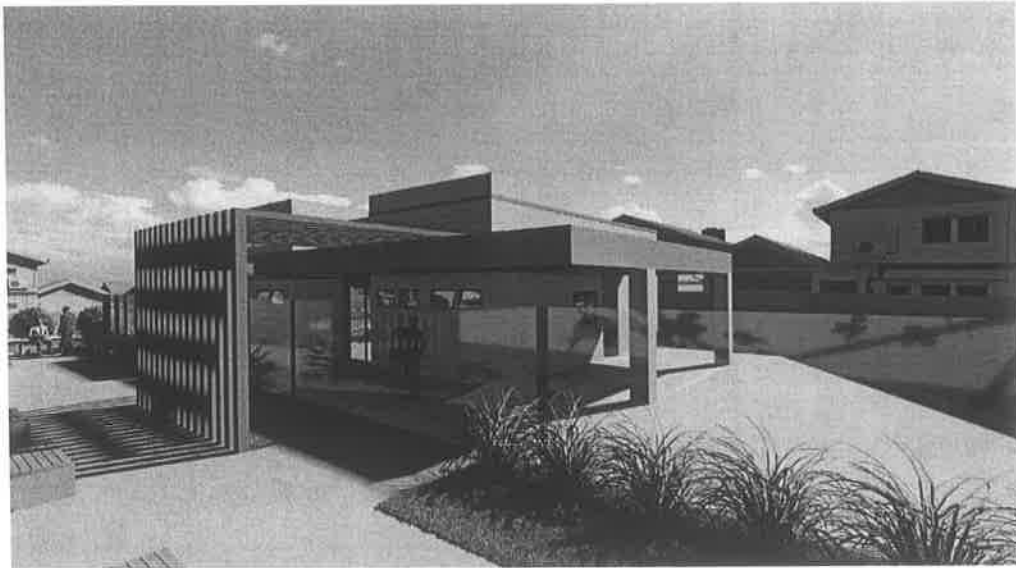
Imagem ilustrativa do pergolado que deverá ser executado na edificação.
